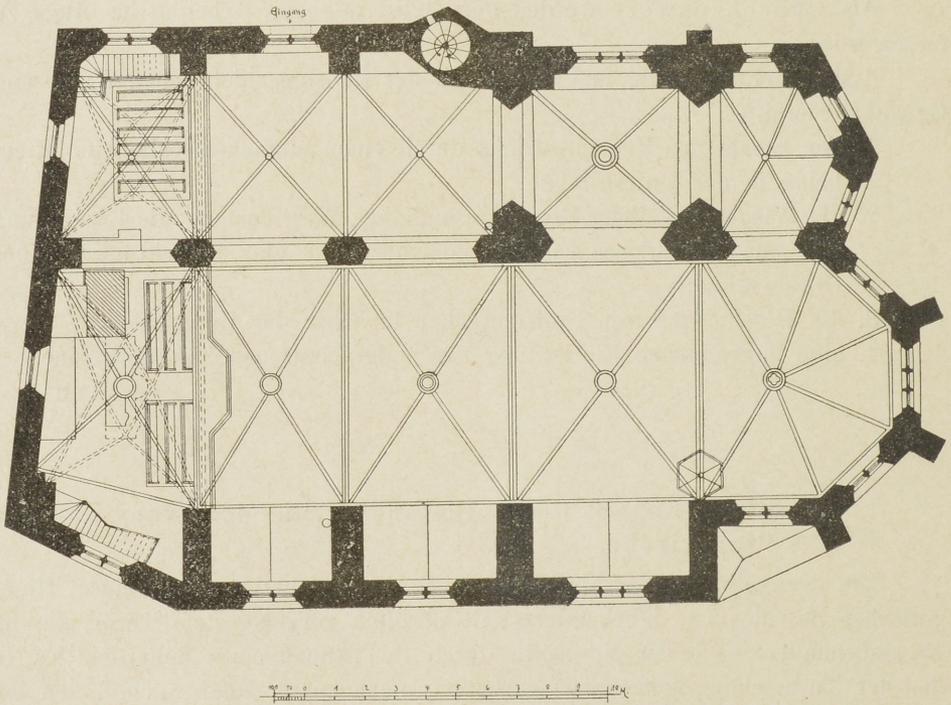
Steeg. Grundriss der evangel. Pfarrkirche.
